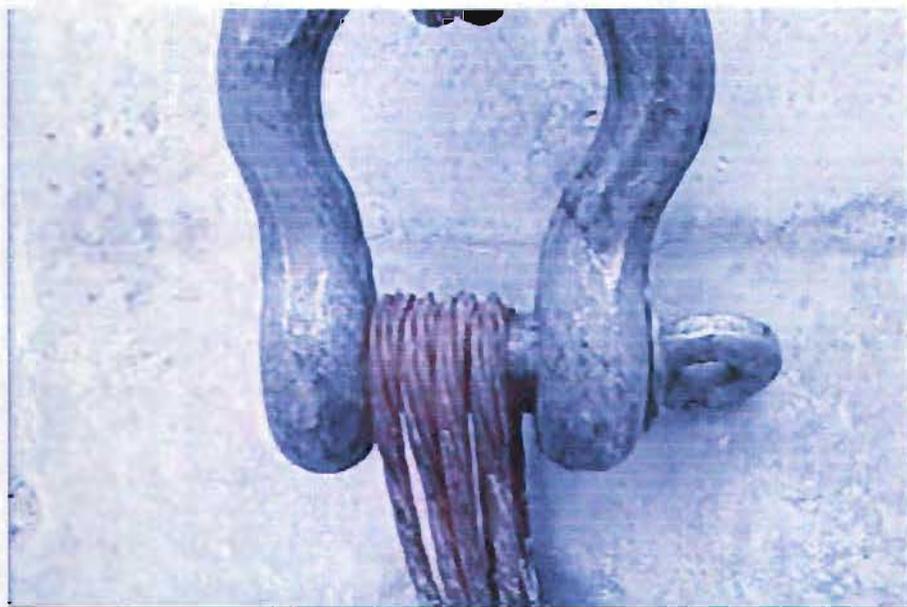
Sujeción del elemento prefabricado.
